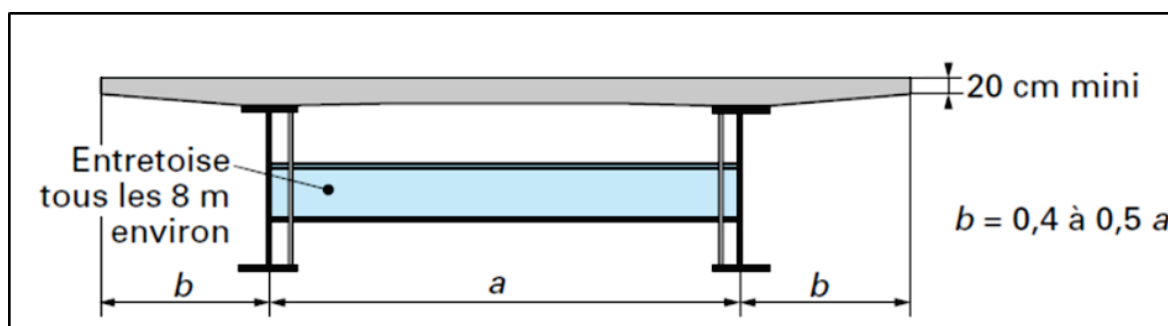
Coupe transversale d'un tablier Bipoutre.
